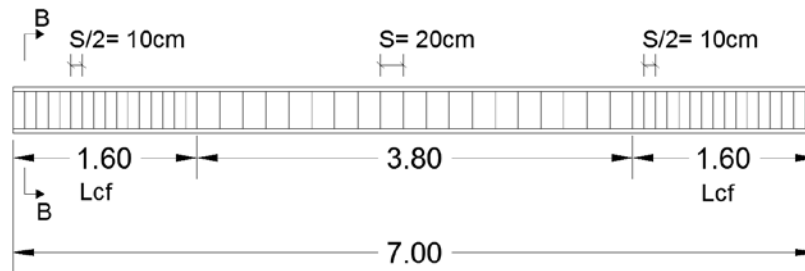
Viga rectangular, sección 40x40. Fuente: Elaboracion Propia.
